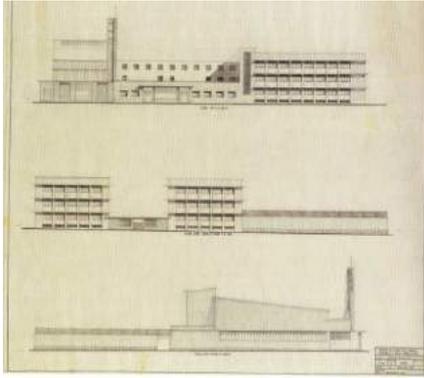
Alzados y Secciones del proyecto original Colegio San José.
